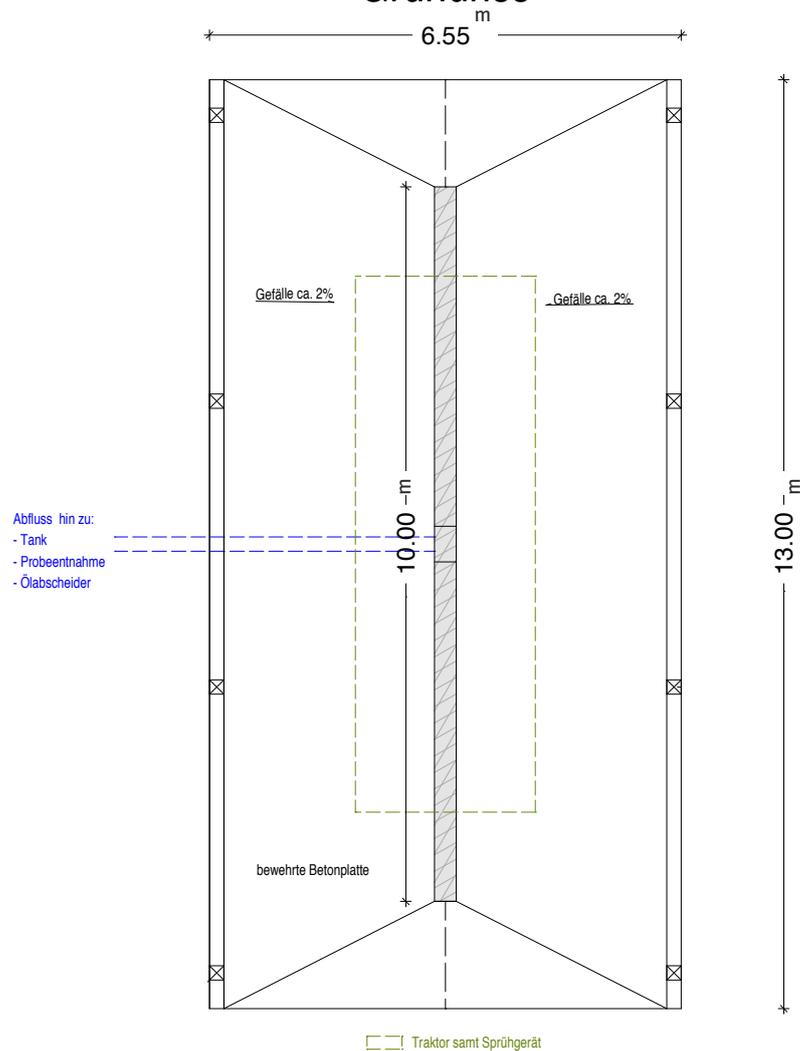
Grundriss überdachter Waschplatz
